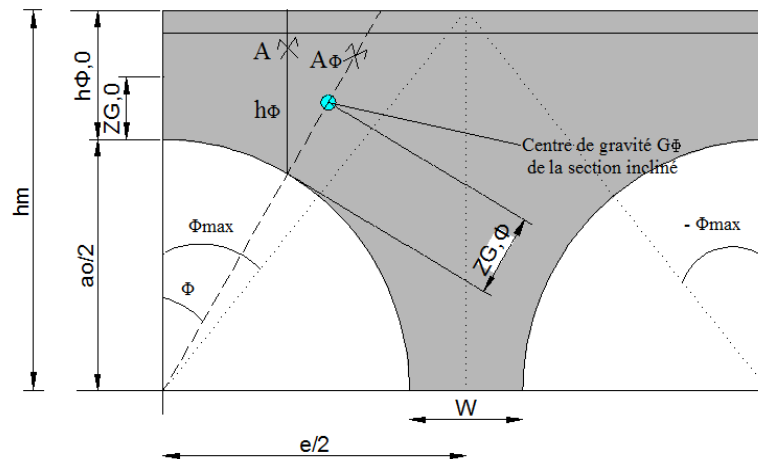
section inclinée à l'endroit d'une ouverture.
